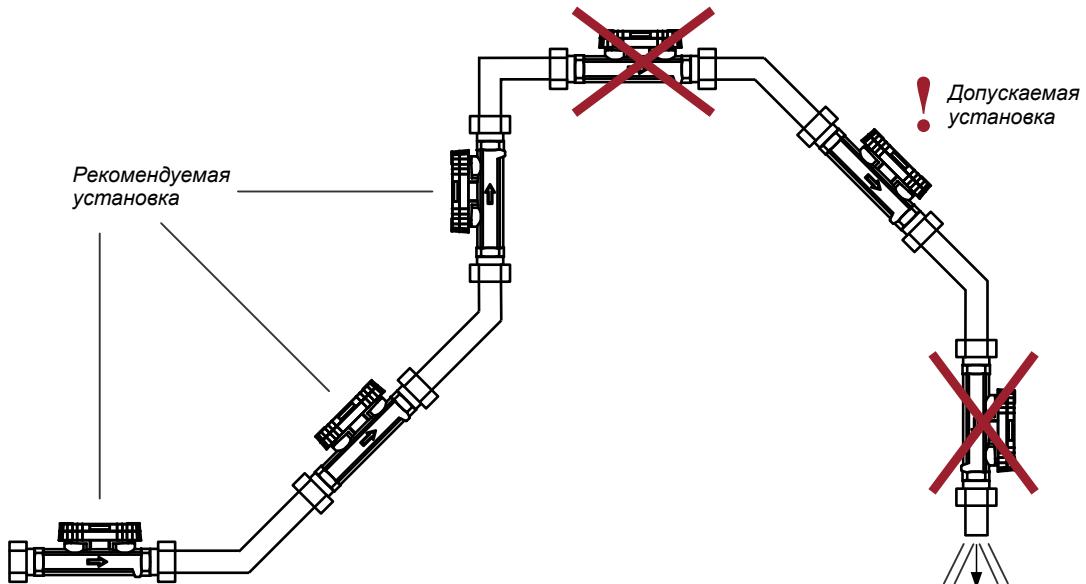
Рекомендуемая установка расходомера в трубопровод
